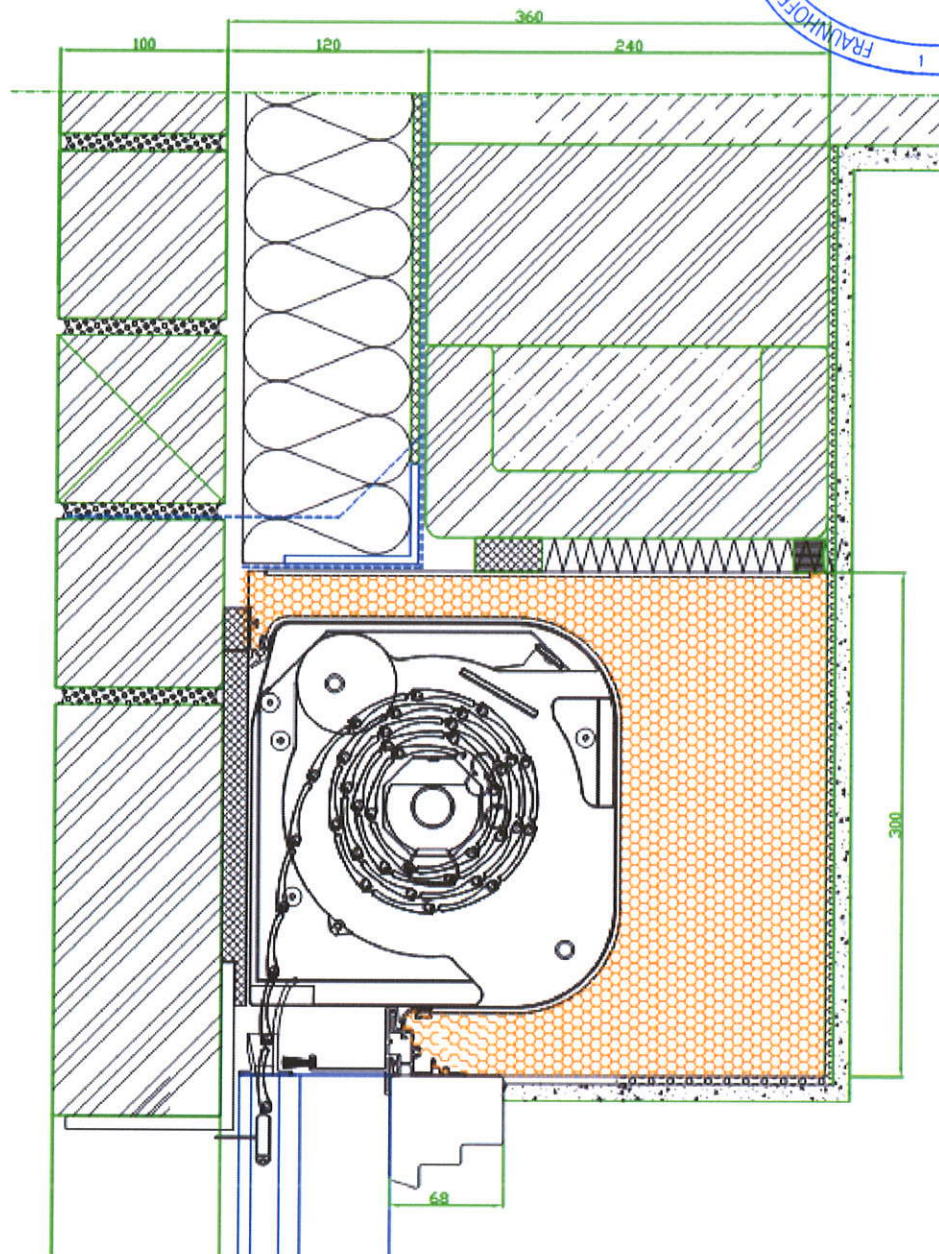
Schnittzeichnung des Prüfobjekts (Zeichnung des Auftraggebers).
